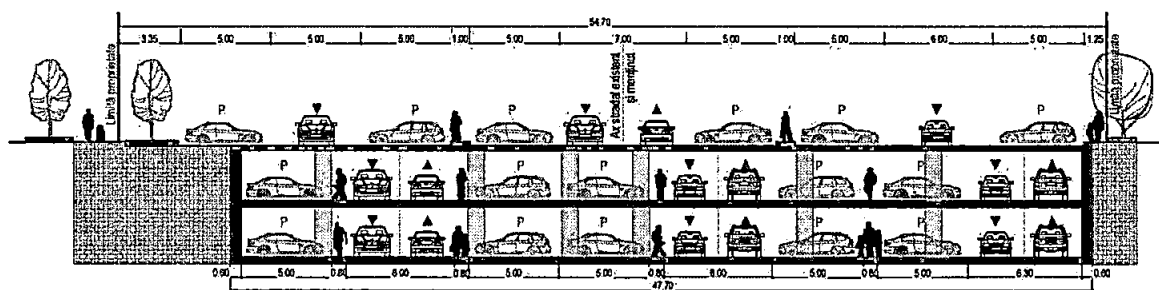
Profilul stradal propus Aleea Daliei – varianta 1
